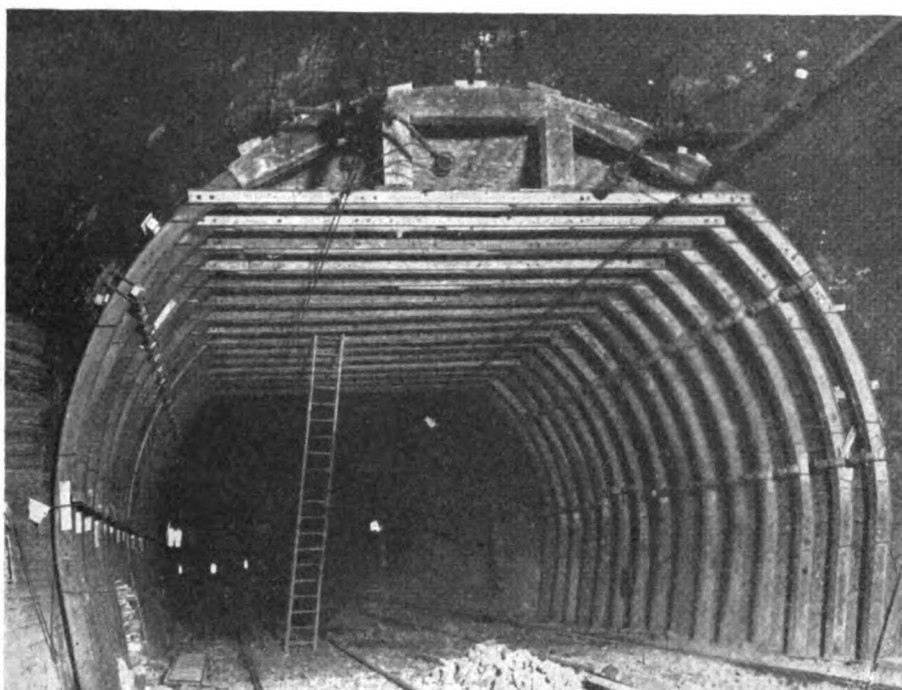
Vista delle centine in ferro per il rifacimento delle murature in calotta.
